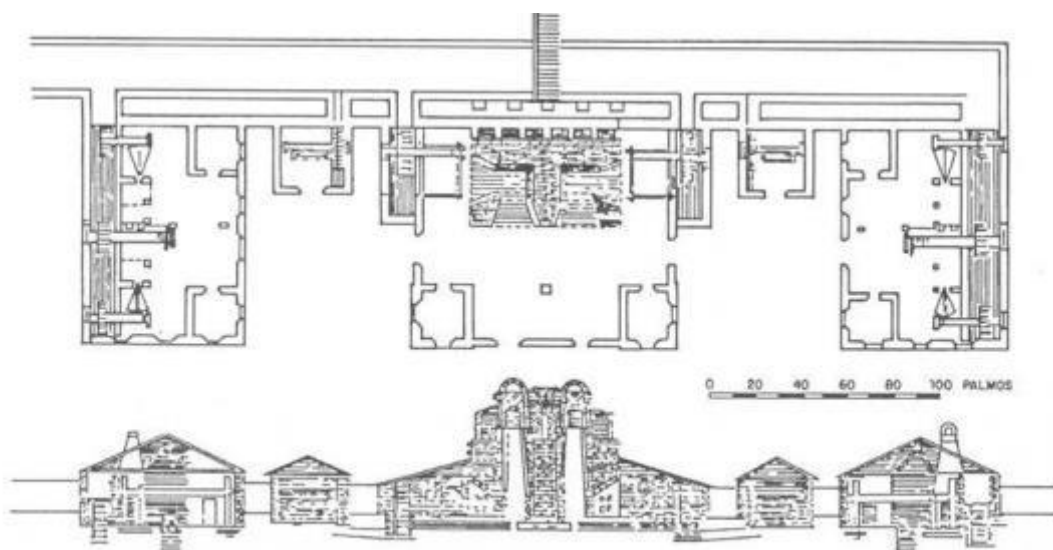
Planta de los Altos Hornos y Refinería de Hierro de São João de Ipanema antes de la restauración
